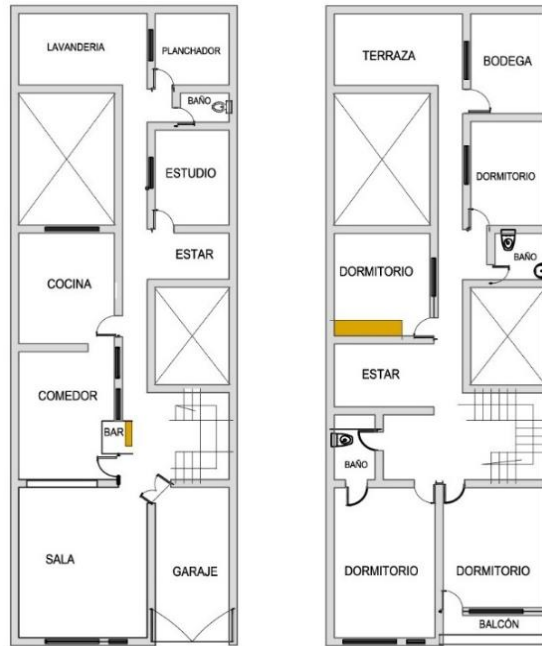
Vistas en planta de la vivienda mediana: (a) planta baja y (b) planta alta.
